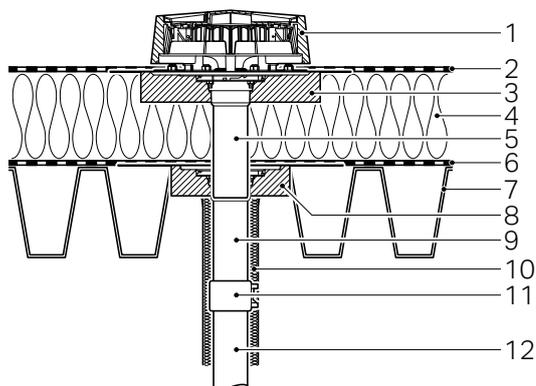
Dachaufbau gedämmtes Dach Leichtbau – Geberit Pluvia Dachwassereinlauf mit Flansch für Kunststoff-Folien
